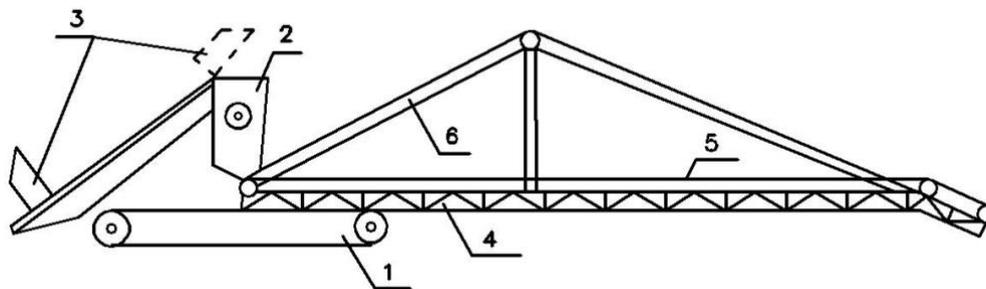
Бетоноукладчик на самоходном шасси:
